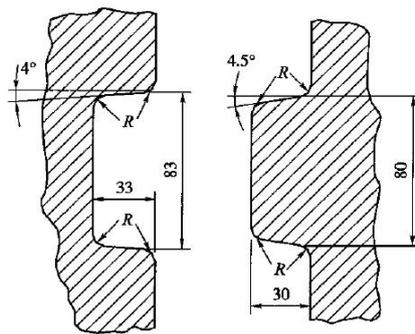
纵向企口连接（尺寸单位：mm）
